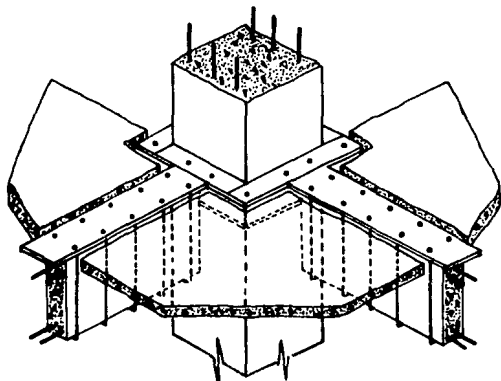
COLLAR DE SOLERAS EN LA UNION VIGA - COLUMNA
